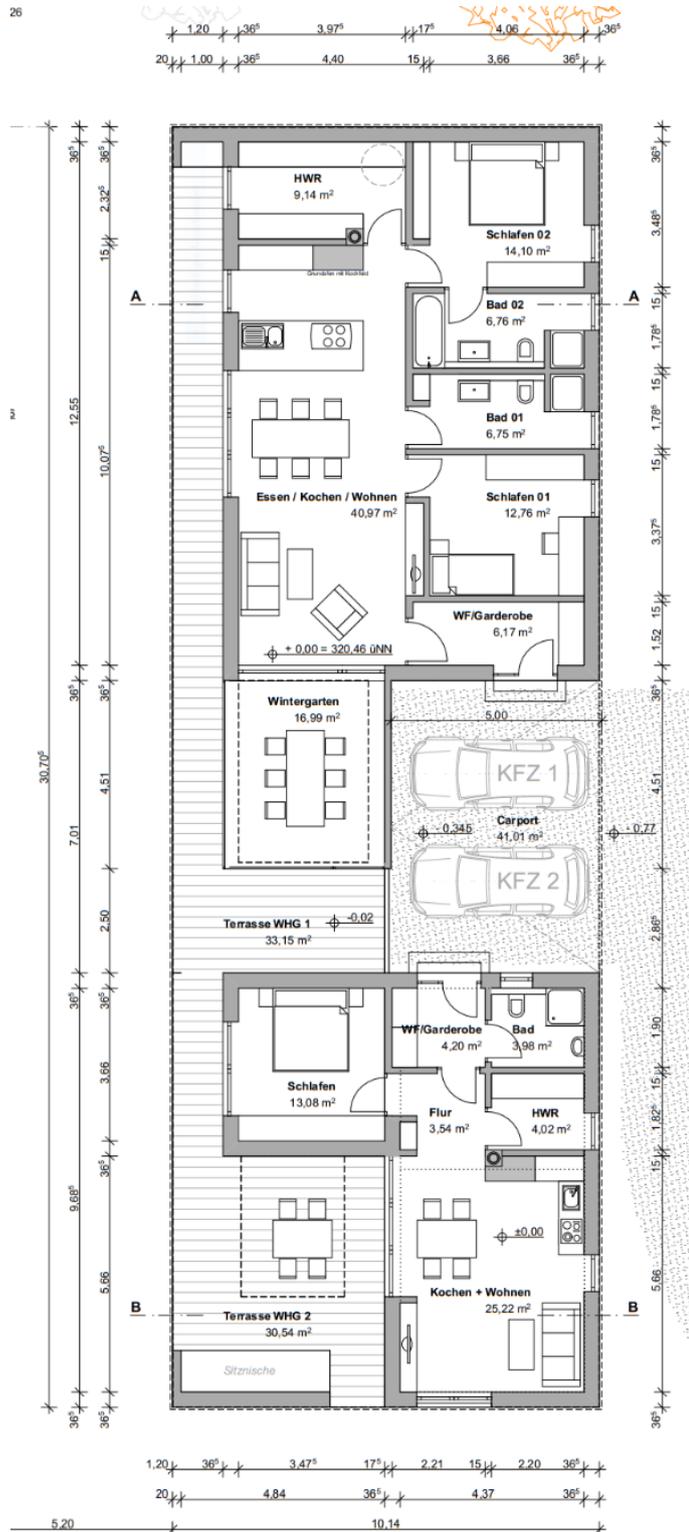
Bemaßter Grundriss<sup>44</sup>
